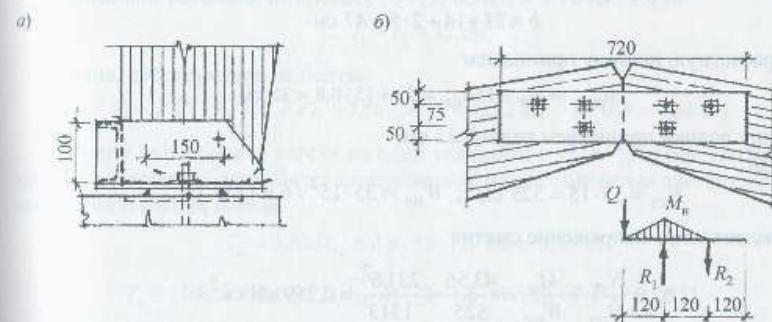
Шарнирные узлы рамы: а – опорный узел; б – общий вид и расчетная схема конькового узла
